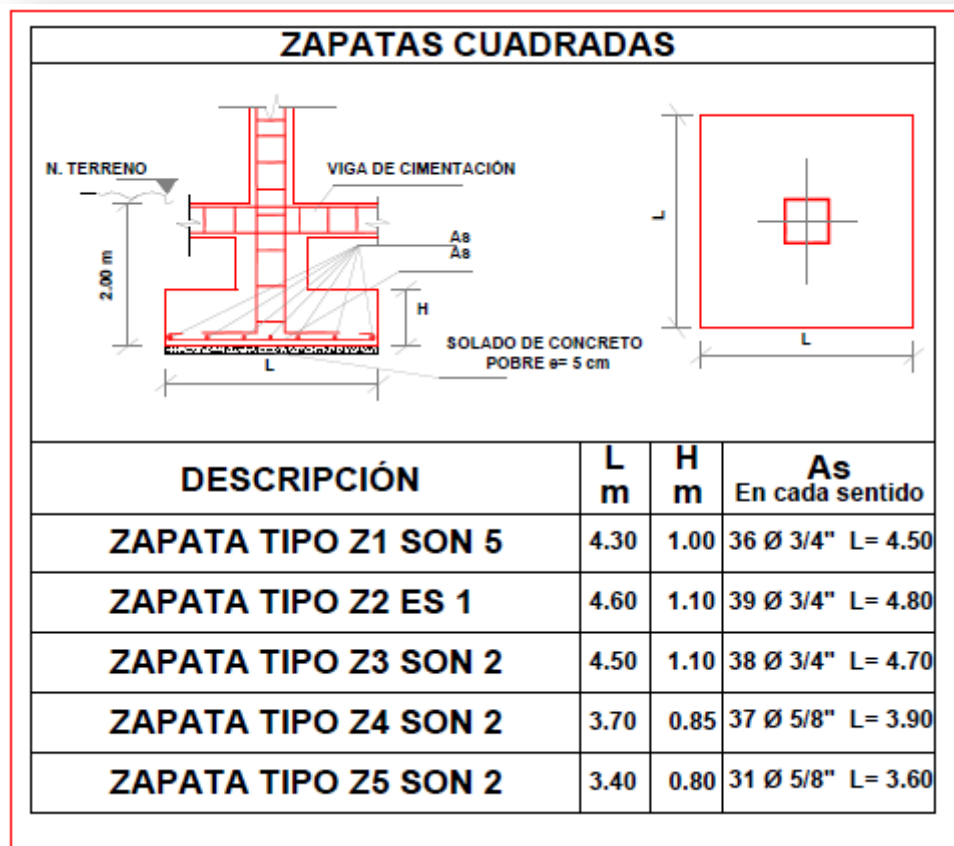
Detalles de Zapata. Fuente: Ing Diego Quiroga
